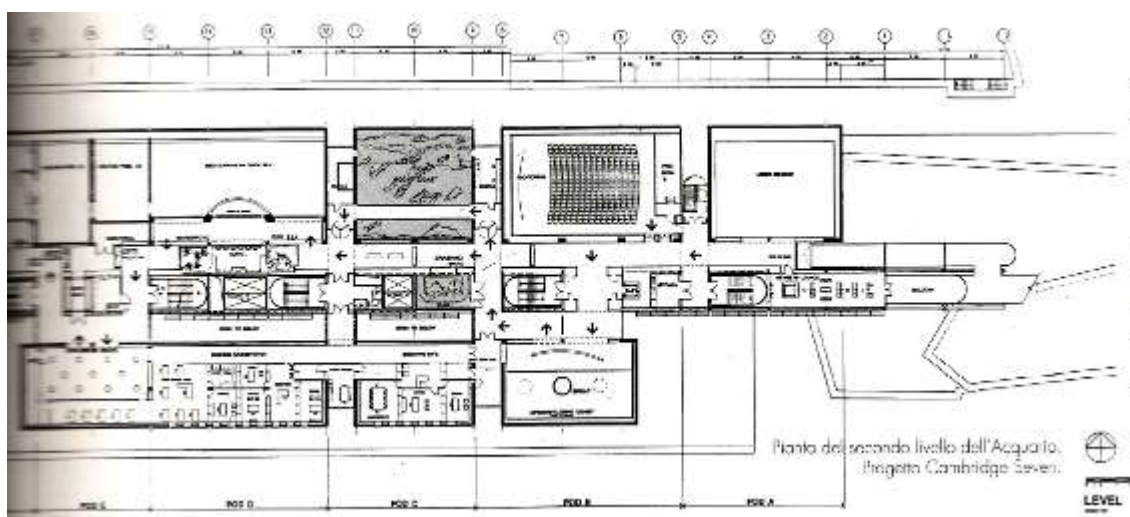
Planta Baixa segundo pavimento do *Acquario
